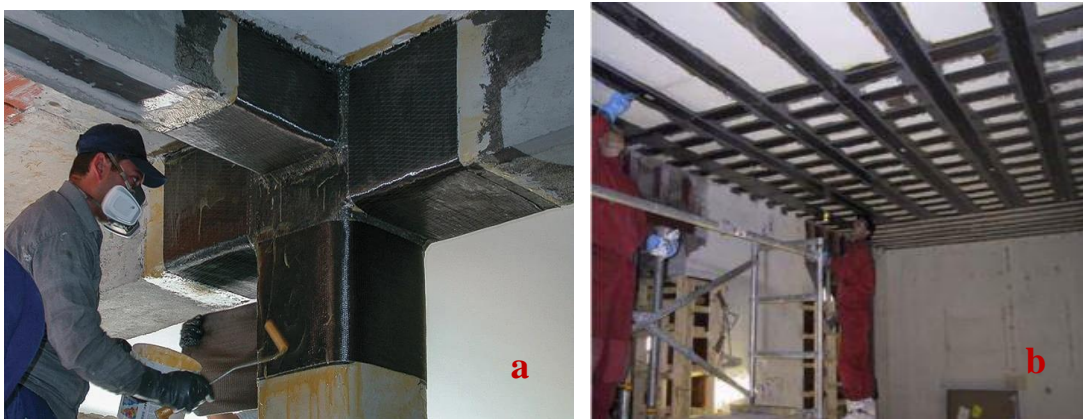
Renforcement par composite : a) Renforcement de la jonction poteau-poutre
